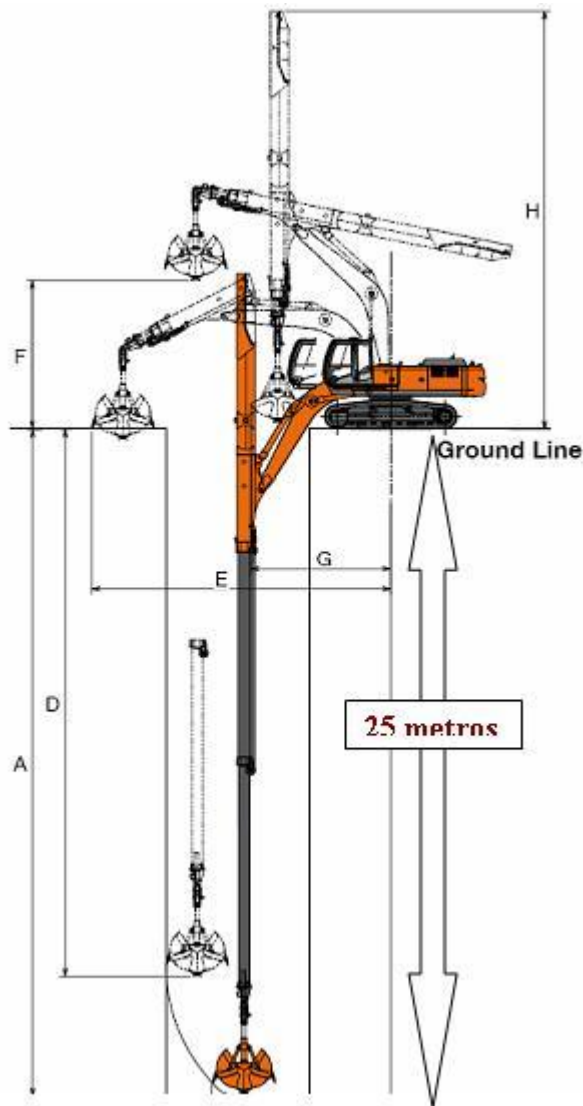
Almeja de construcción para excavación de zanjas de muros colados
